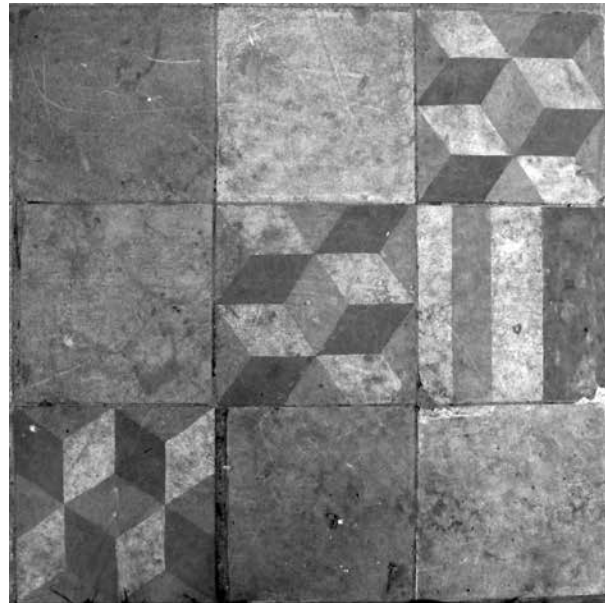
Detalle del pavimento del corredor del patio. Fotografía de Enrique Tovar.
